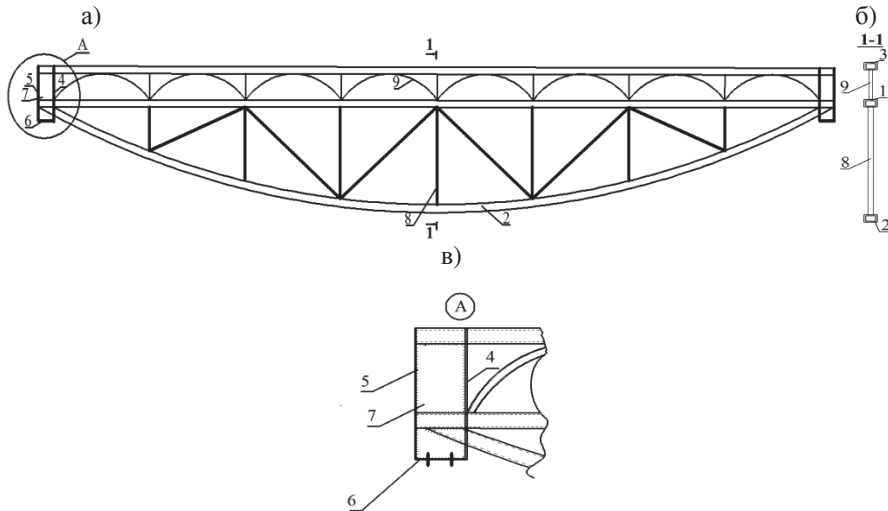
Комбінована металева конструкція ферми: а – загальний вигляд; б – розріз 1-1; в – вузол «А»
